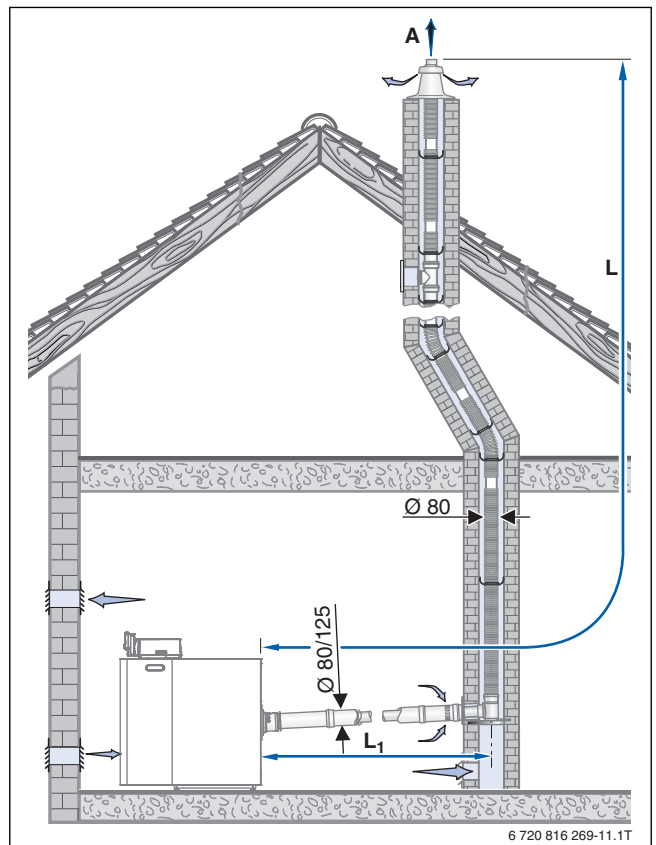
Conducción por tubo individual en la chimenea, (B₃₃, flexible)
